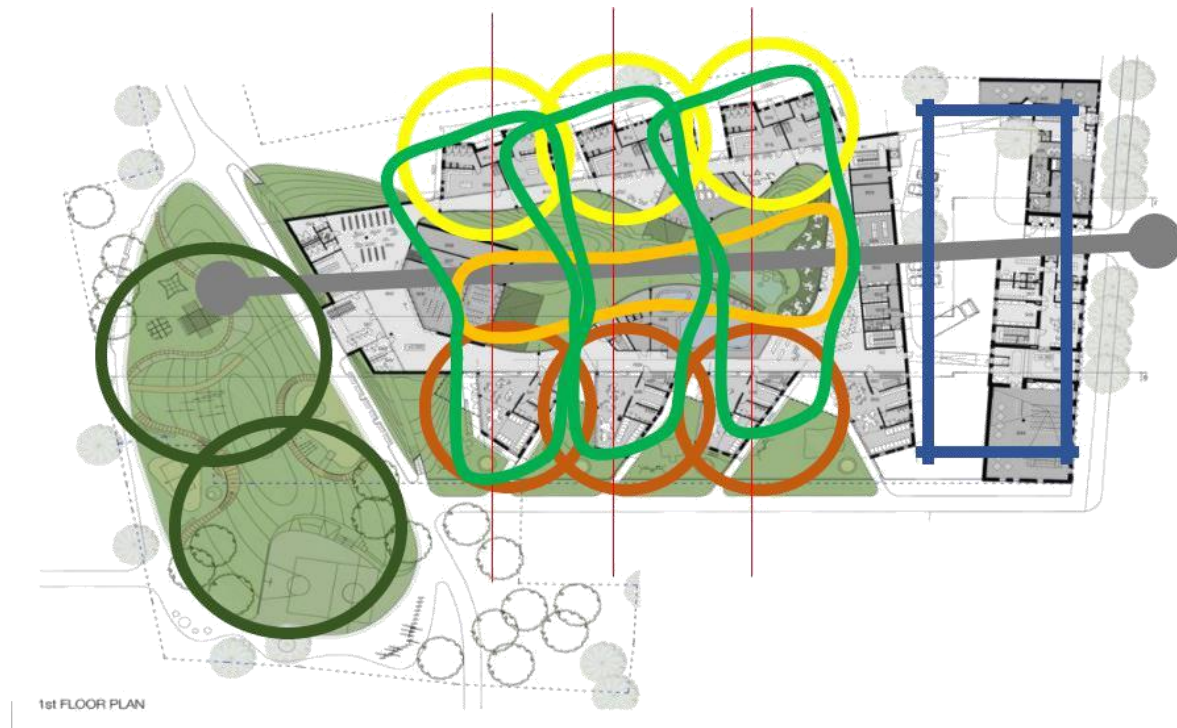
Planta Tipología –Propuesta para Jardín en Riga
